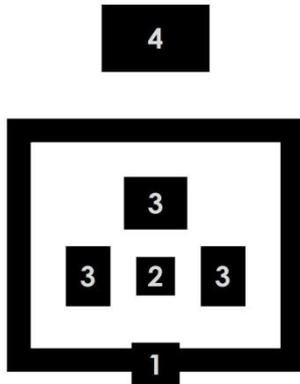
, Grundriss des Asuka-dera, Japan, 588 n. Chr.
